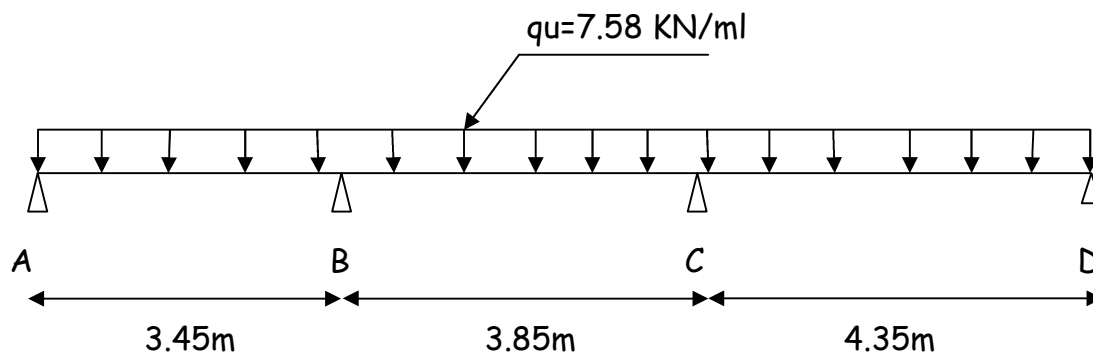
Schéma statique de la poutrelle continue reposant sur 4 appuis.
